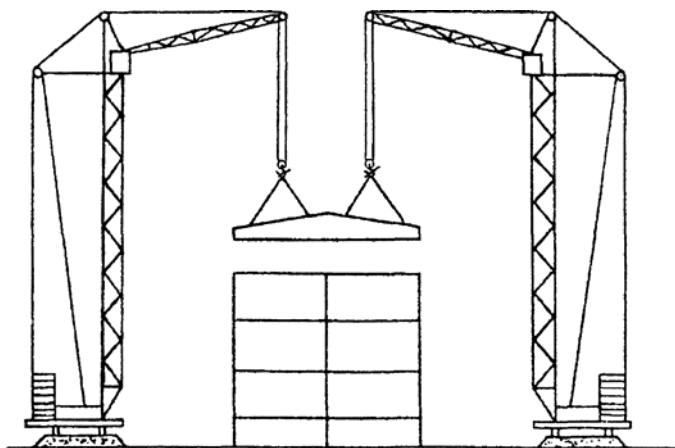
Схема спільного монтажу елемента покриття двома кранами
